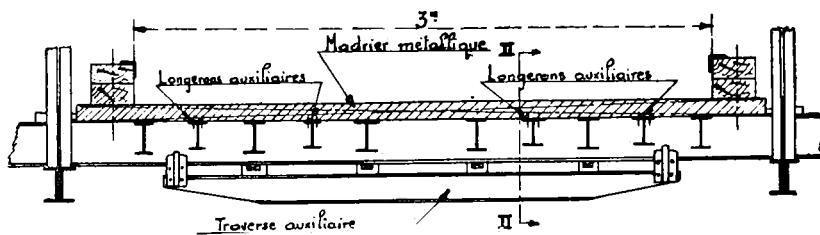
Coupe et vue suivant I I de la figure 61.
